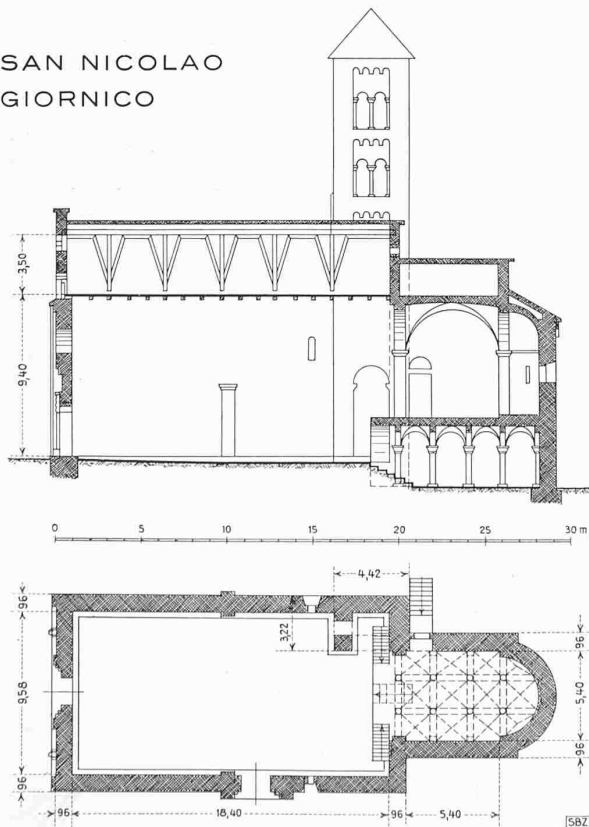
u. 5. Grundriss und Längsschnitt. — Masstab 1 : 400
